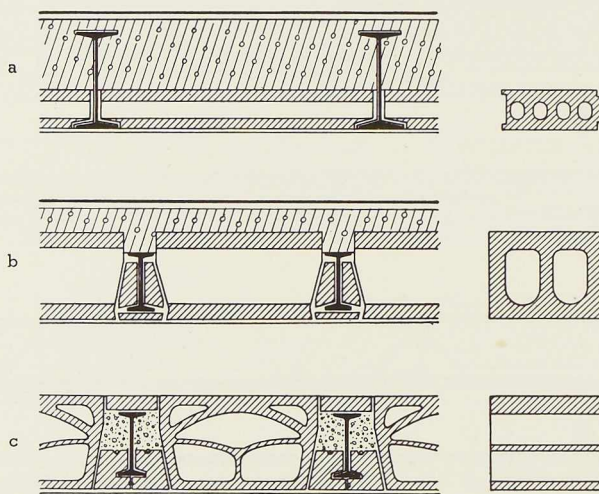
Type d'éléments en corps creux servant de coffrage au béton.
